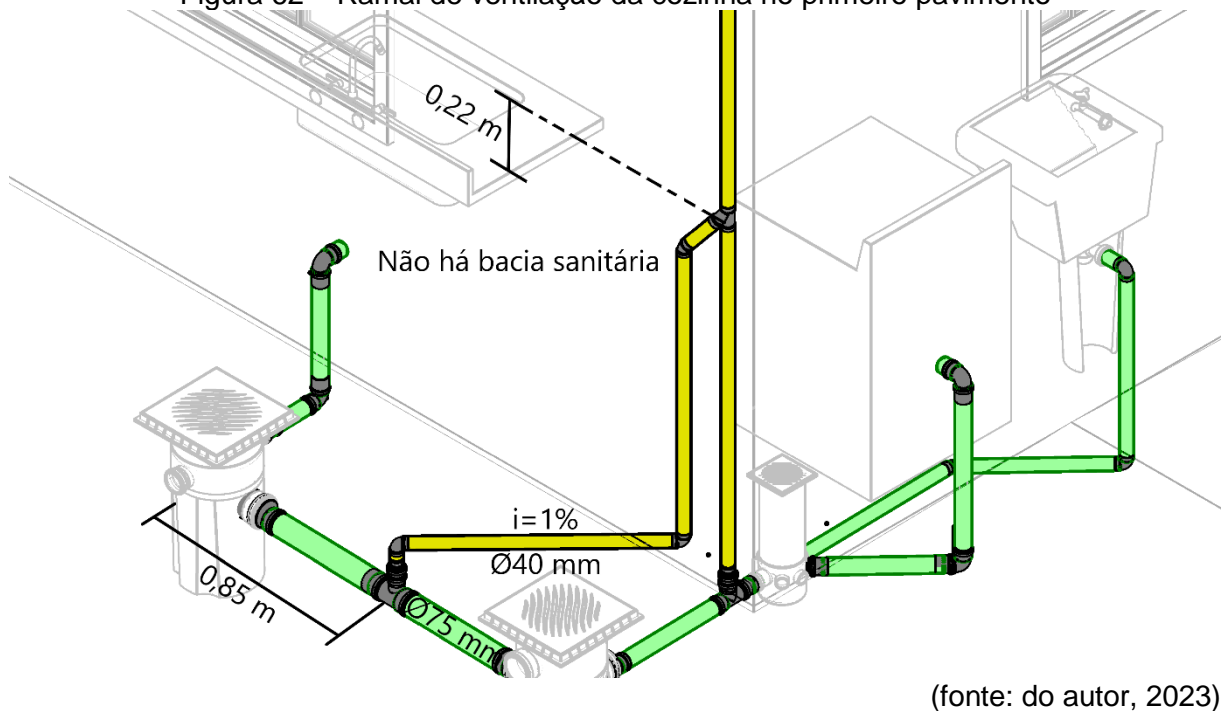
Ramal de ventilação da cozinha no primeiro pavimento
